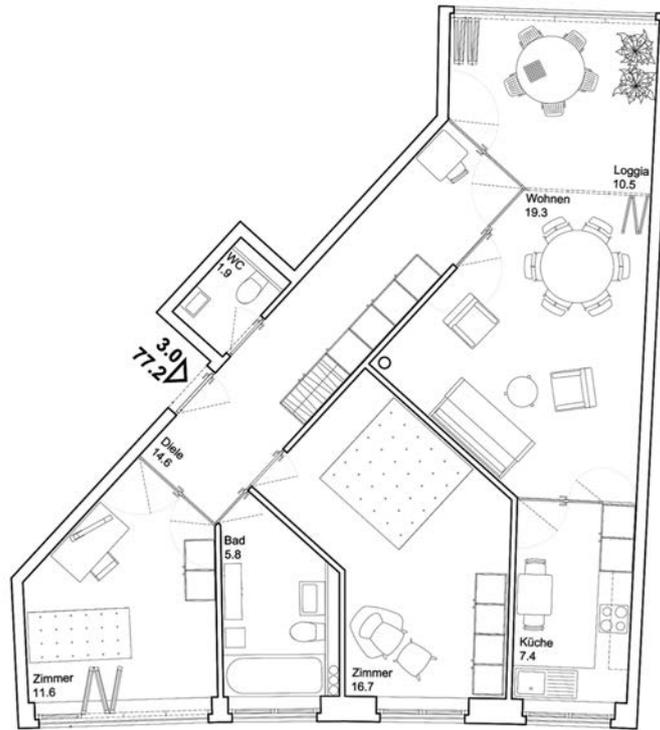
Wohnungsgrundriss 3 Zimmer - Whg.
